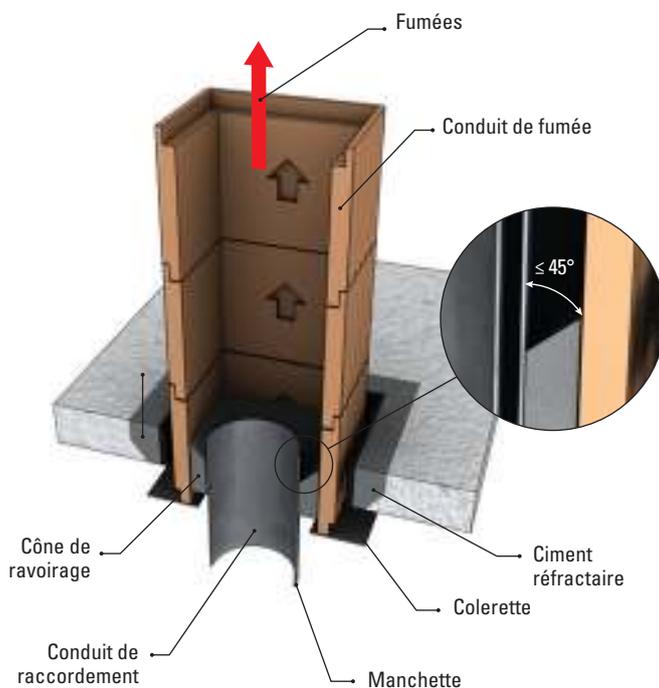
Exemple de scellement d'une colerette à un conduit de fumée maçonné en attente au plafond
